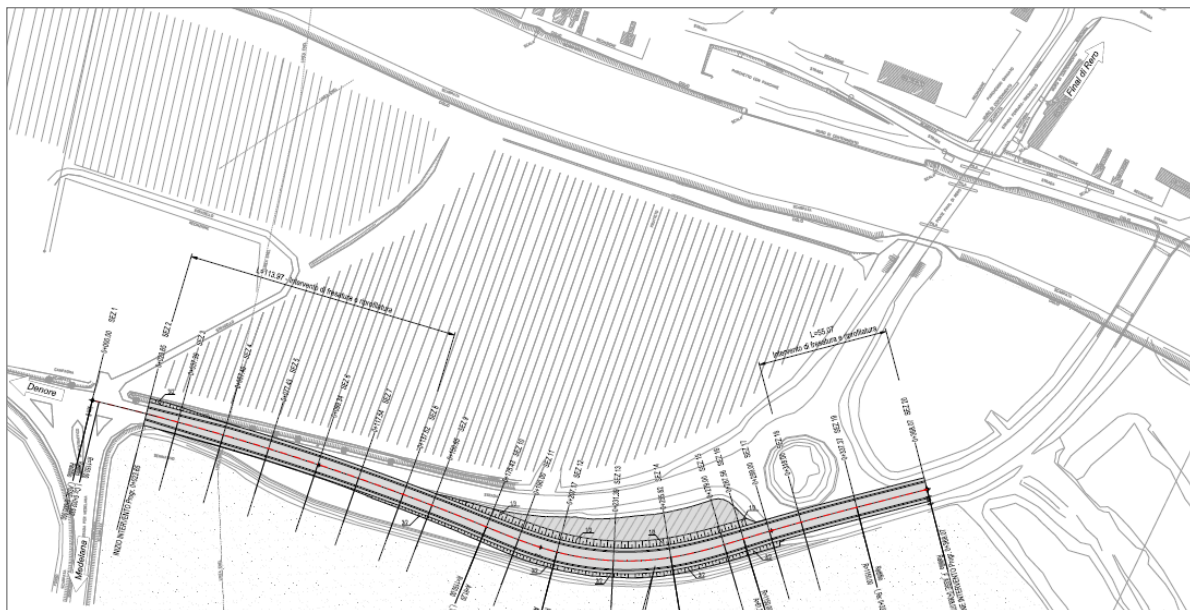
Viabilità provvisoria di cantiere durante la demolizione e ricostruzione del ponte di Final di Rero
